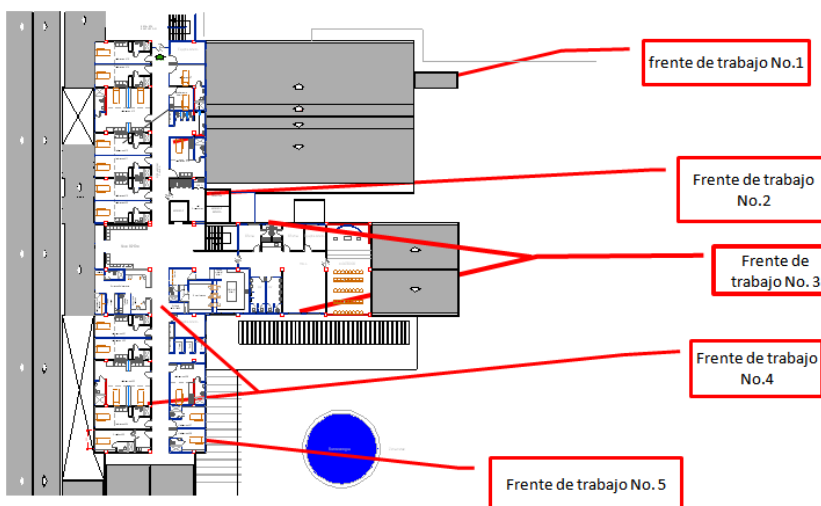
Planta arquitectónica del quinto piso donde se comenzó la realización de la obra.
